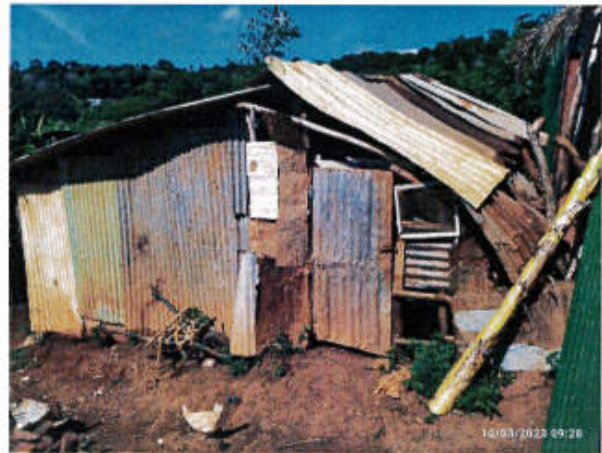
construction formée par assemblage de matériaux hétéroclites en mauvais état
